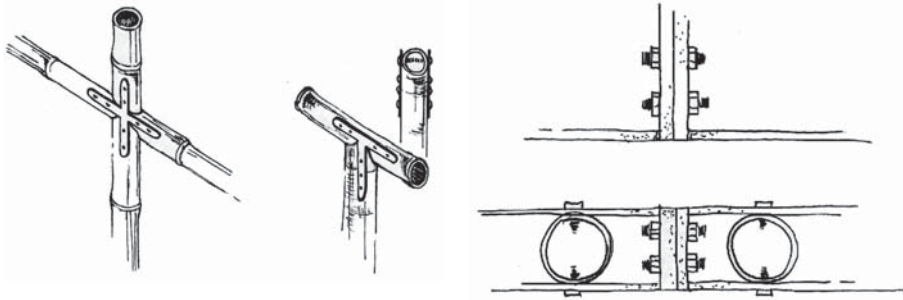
Pilar com viga (Desenho da autora). Figura 17. Pannel com pannel (Desenho da autora).
